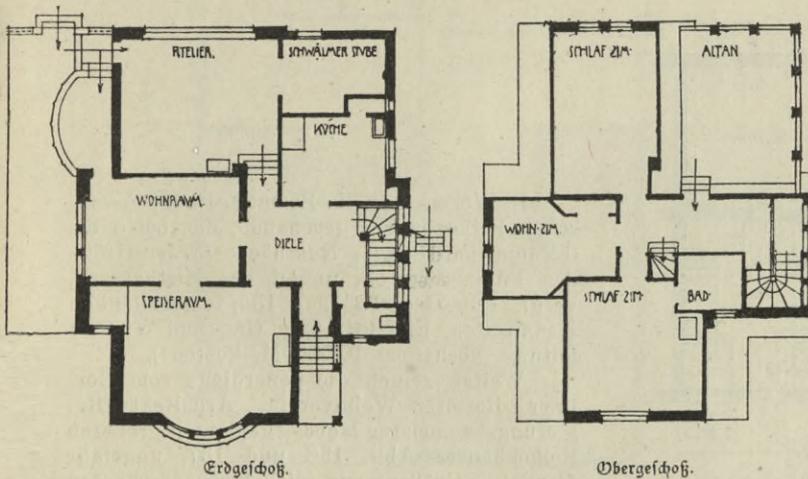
und 129. Landhaus Beithan in Buchschlag
